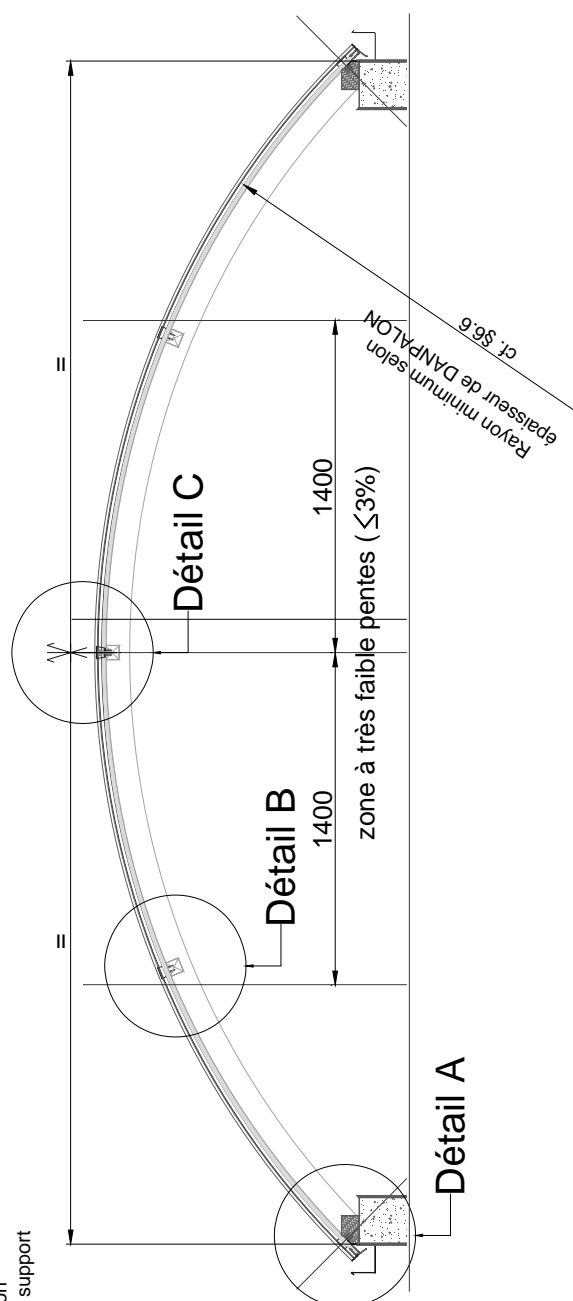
Pose cintrée - Coupe longitudinale et transversale sur connecteur polycarbonate
